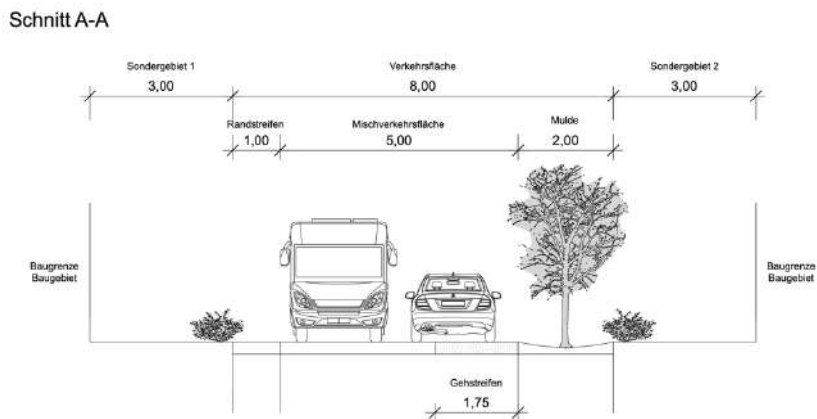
möglicher Straßenquerschnitt A-A – Verkehrsfläche inklusive Grünstreifen mit Versickerungsmulde
